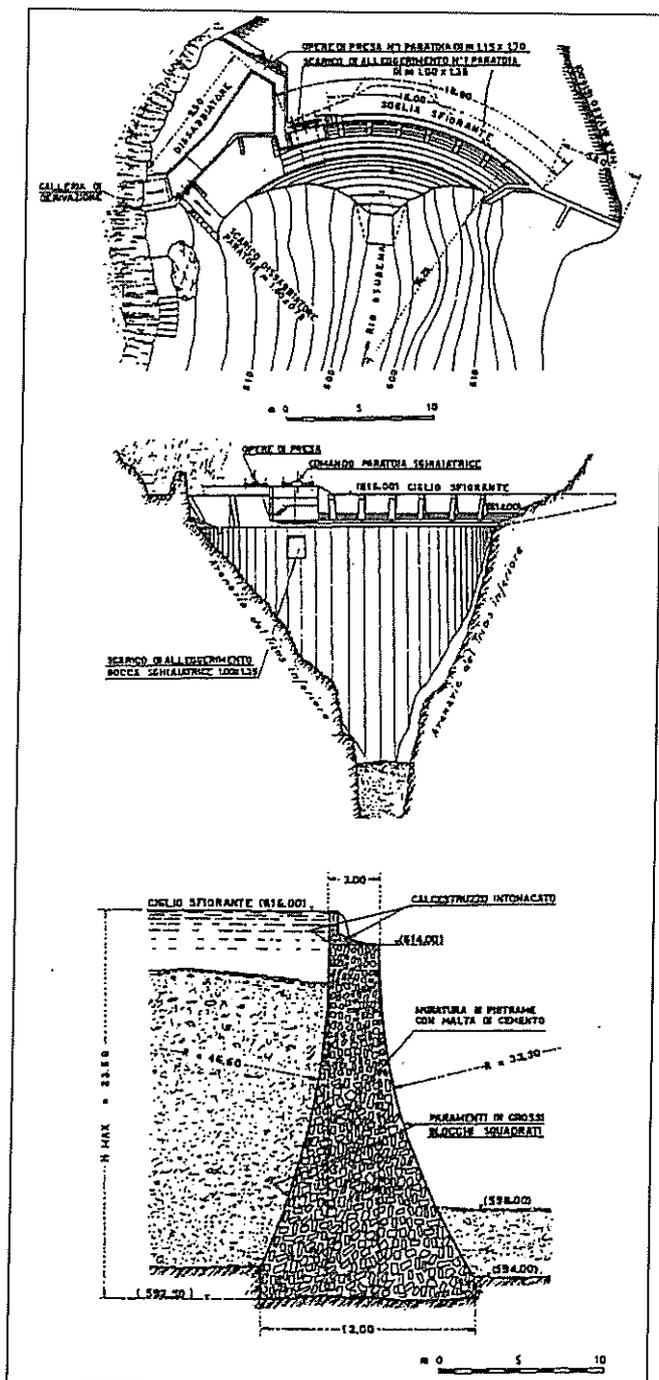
Diga di Pontealba: Planimetria - Vista da valle - Sezione tipo.
